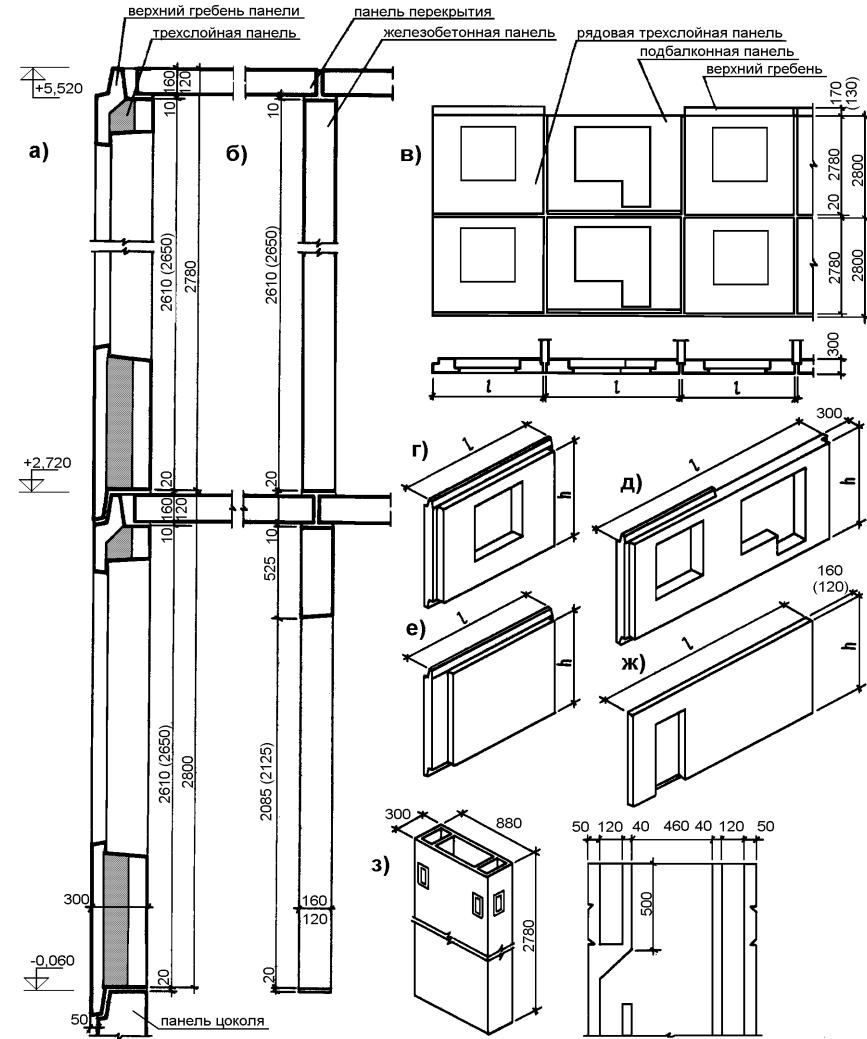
Наружные стены из трехслойных железобетонных панелей.
